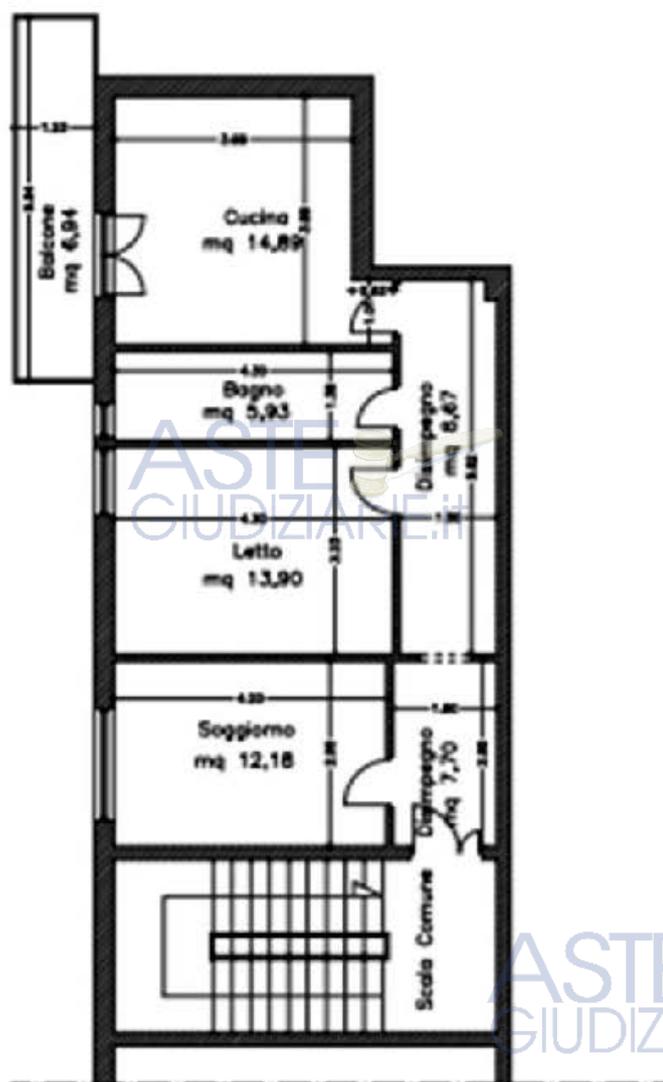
(Allegato n. 7 – Planimetria stato di fatto)
